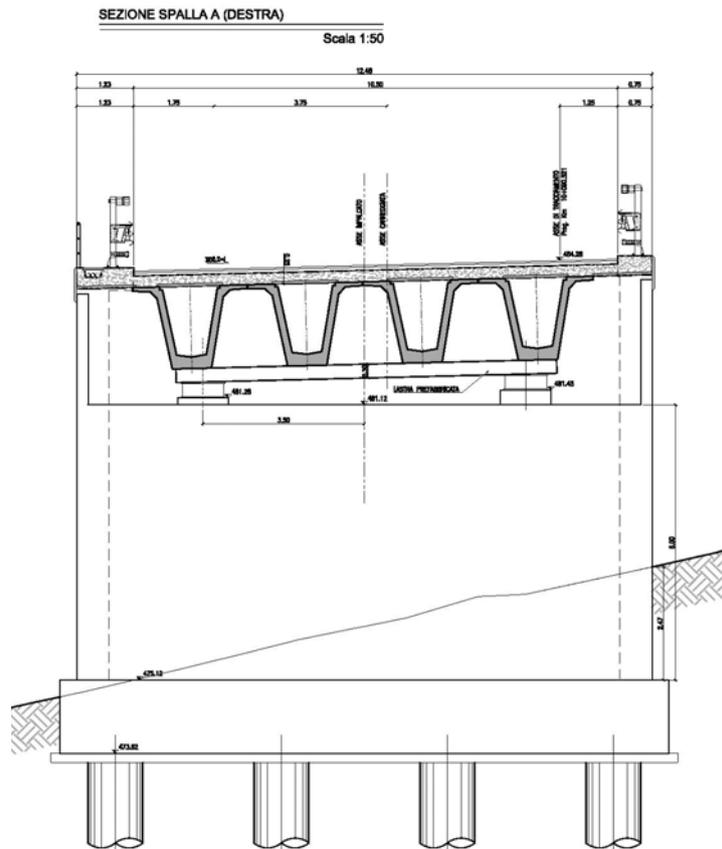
Sezione trasversale dell'impalcato in asse alla spalla A carreggiata DX
